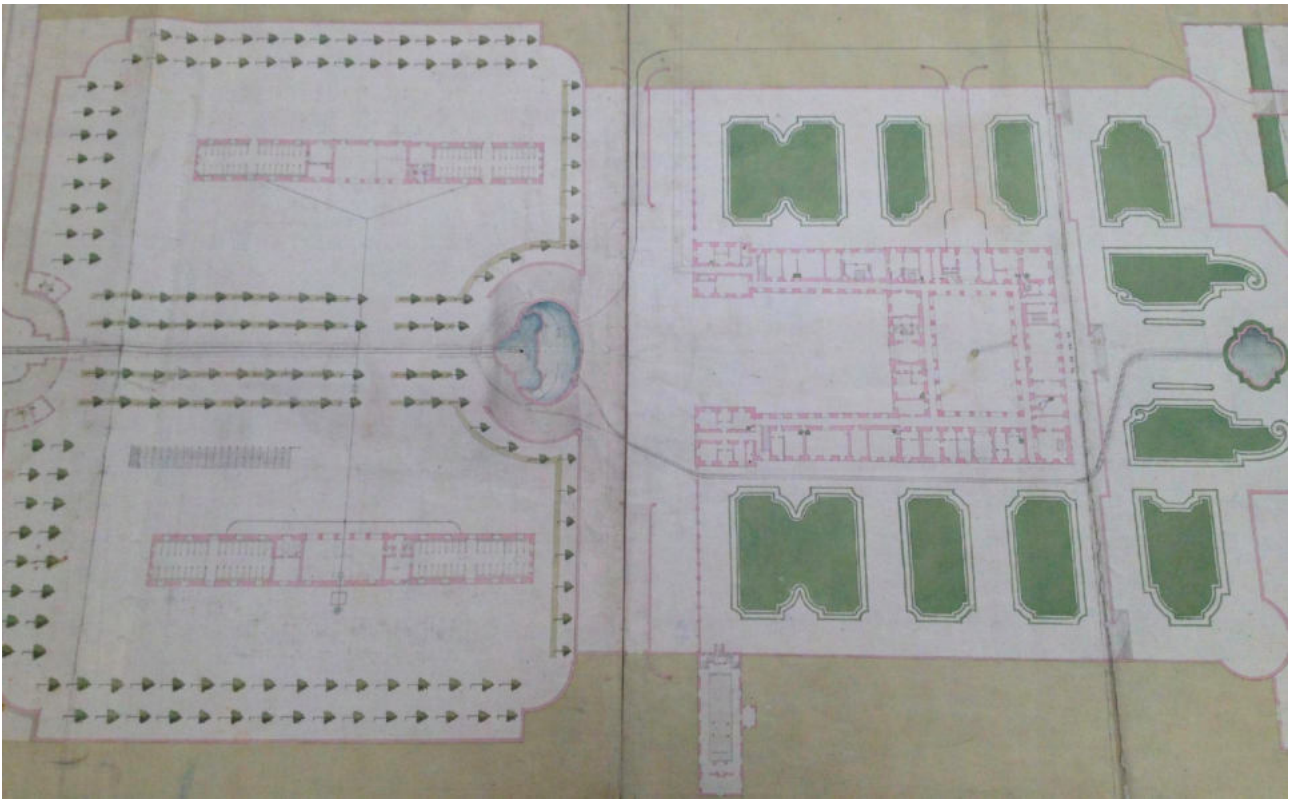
Grundriss des Schlosses Hof, Federzeichnung, um 1775
